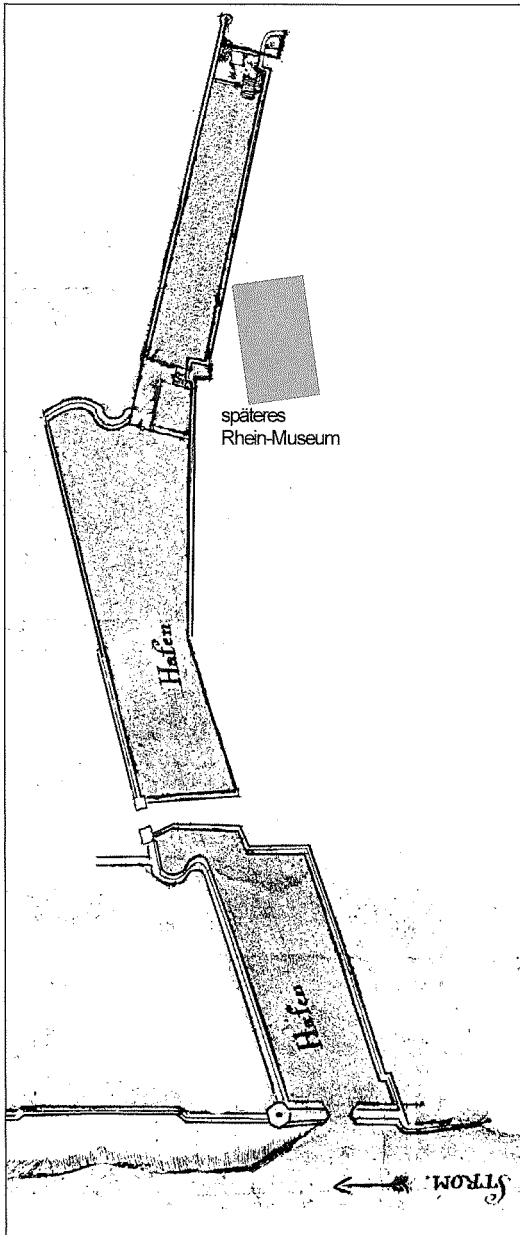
Dieser Hafen im Grundriss⁴.
